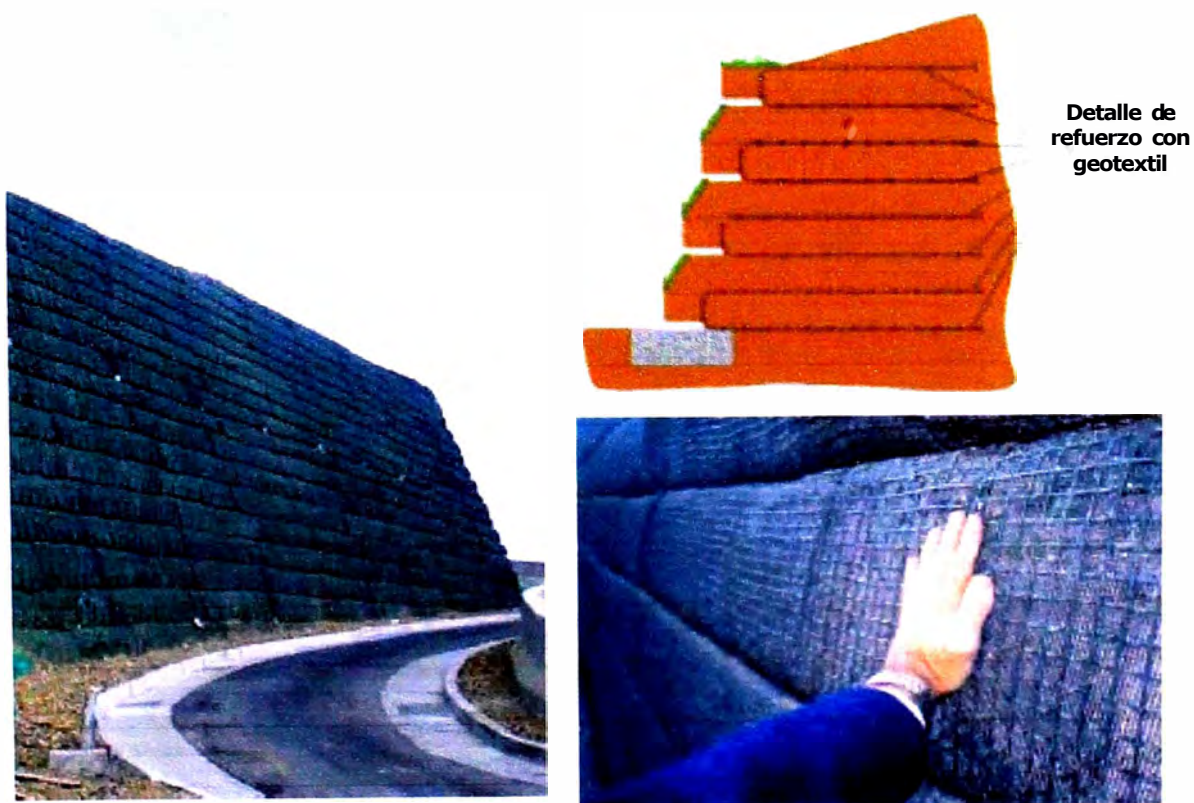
Muro de Contención Reforzado con Geotextil.
